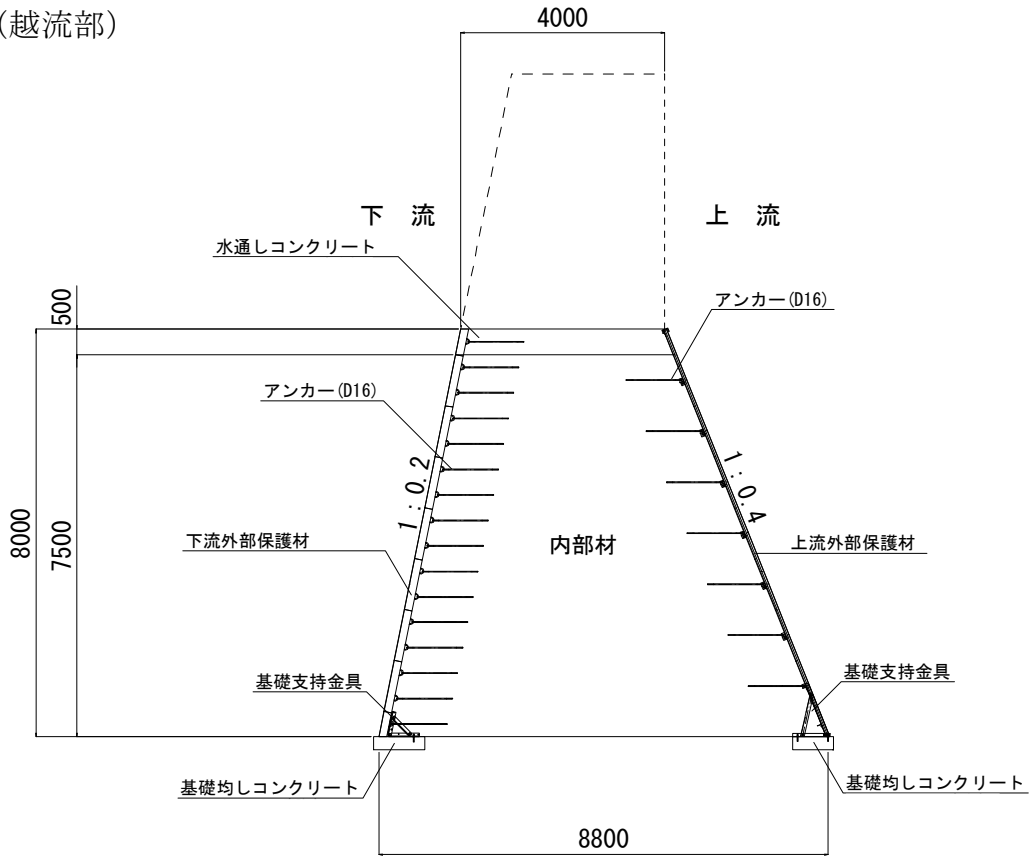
SBウォール工法 基本断面形状 (タイプ1: 台形断面)
